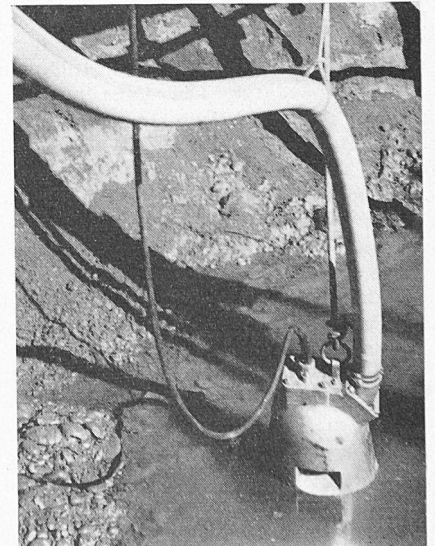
(rechts). Baugruben-Tauchpumpe Flyght
